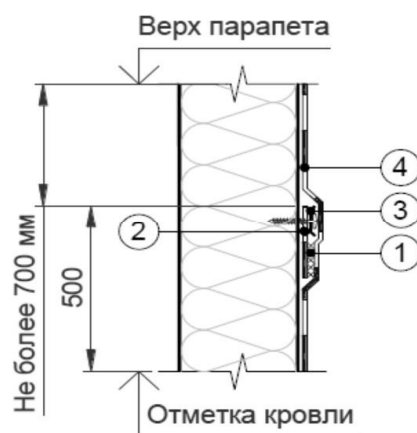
Примыкание кровли к стене с механическим креплением края кровельного ковра.
